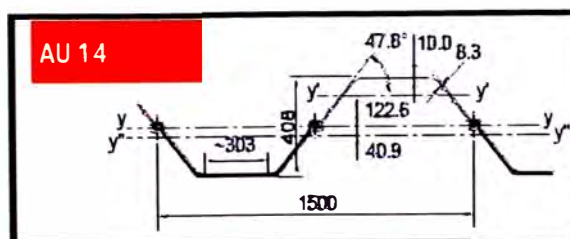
Detalles geométricos de la tablestaca tipo AU – 14 (medidas dadas en mm)
